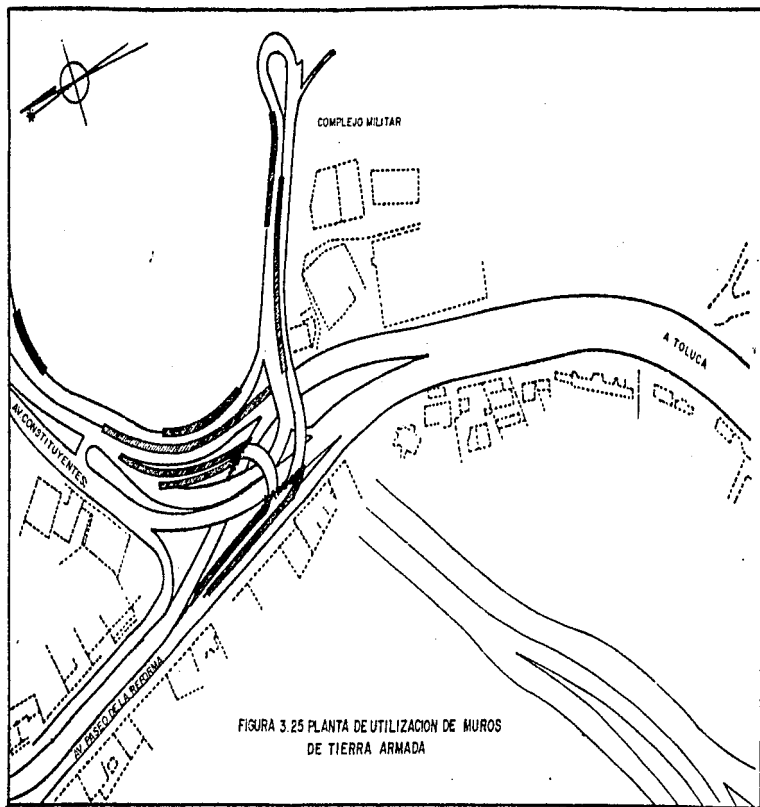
PLANTA DE UTILIZACION DE MUROS
